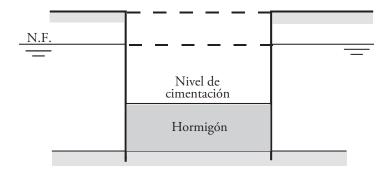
Excavación con hormigón vaciado al fondo para evitar subpresiones.
